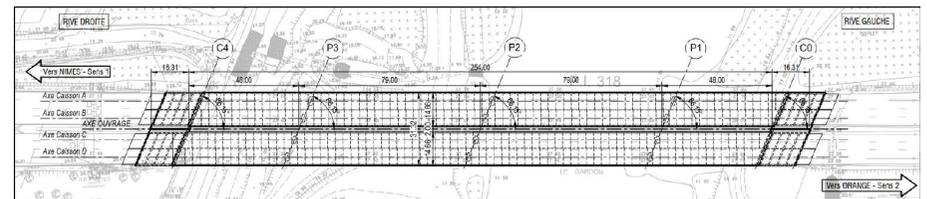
Vue en plan de l'ouvrage (Arcadis, 2022)
